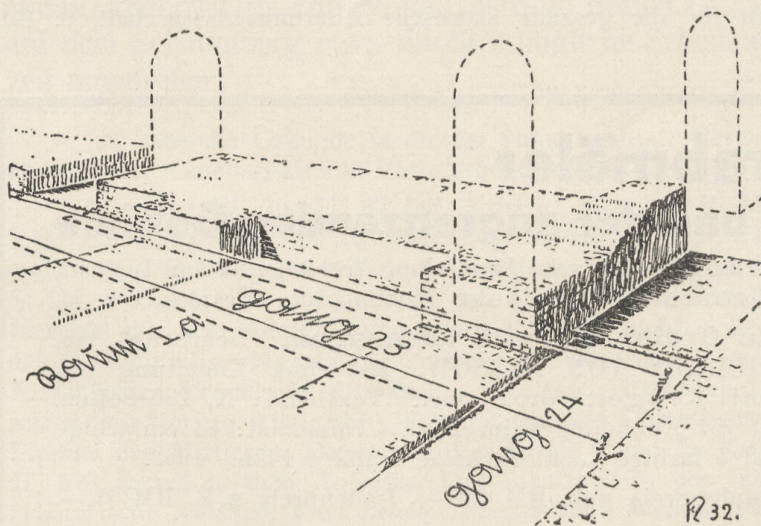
Darstellung des Bauvorganges. Es wird gezeigt, wie über den mit einer durchgehenden (1 Steinschicht hohen) Fundamentsohle angelegten Raumgrundriss, vgl. Abb. 1 u. 2. Gang 23 ausgeflucht ist und wie seine Breite dort, wo er von Mauern des Raumgrundrisses überschritten wird, ausgespart wird. Die schräg über die Bildmitte laufende breite Mauer ist die Ostmauer von F. Die sich an den Seiten von Gang 23 bildenden Nischen werden später ausgemauert (vgl. Abb. 2)
